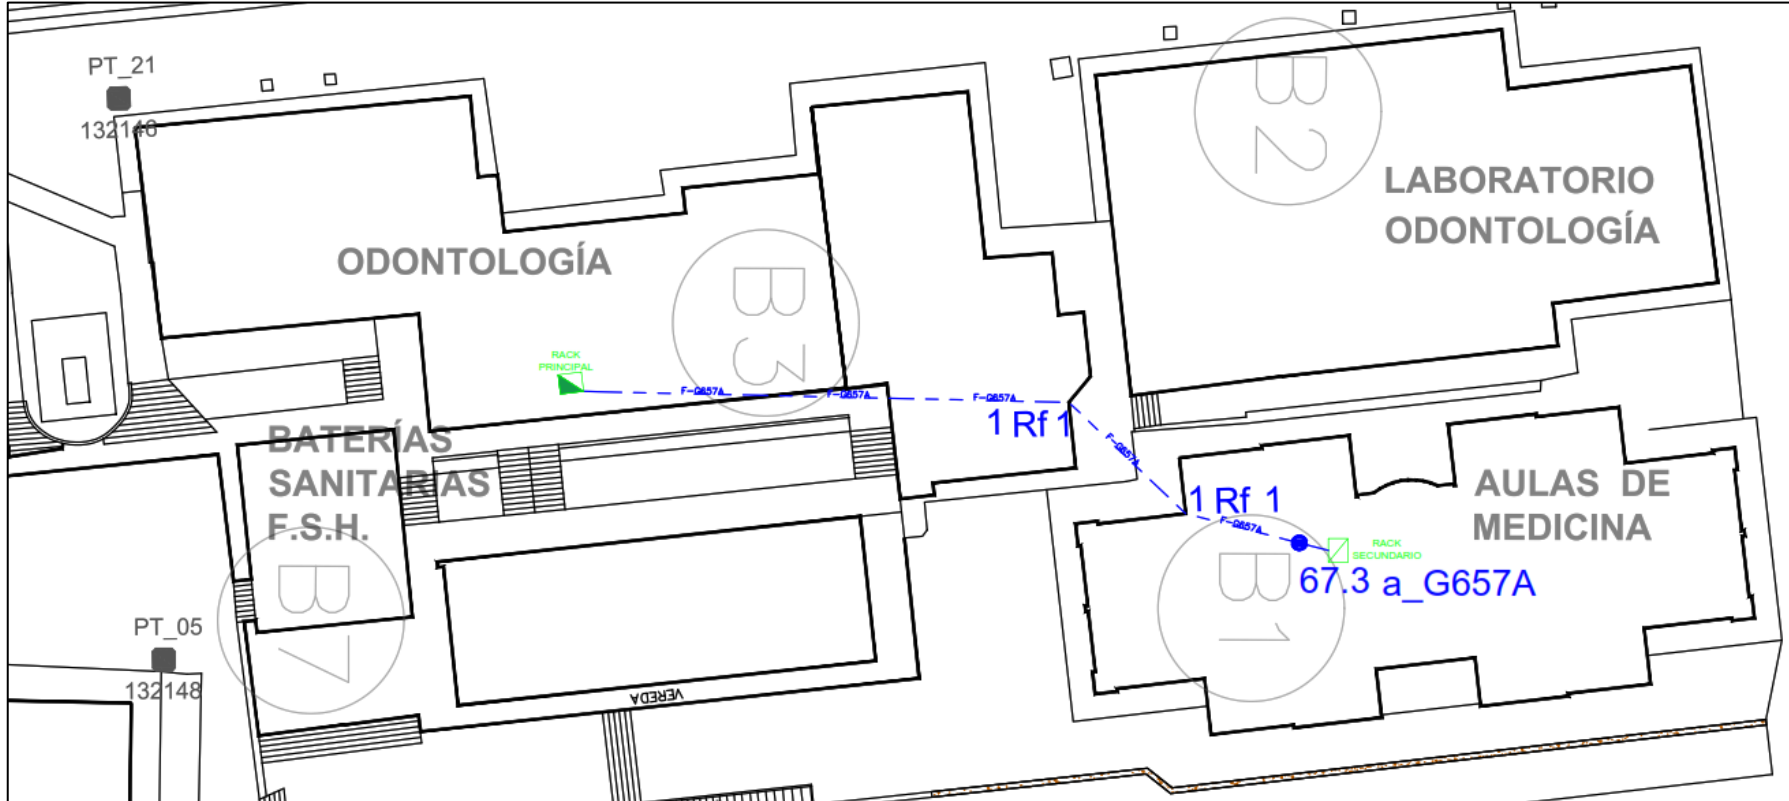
Planimetría del tendido aéreo para el enlace de fibra óptica del bloque 1.
